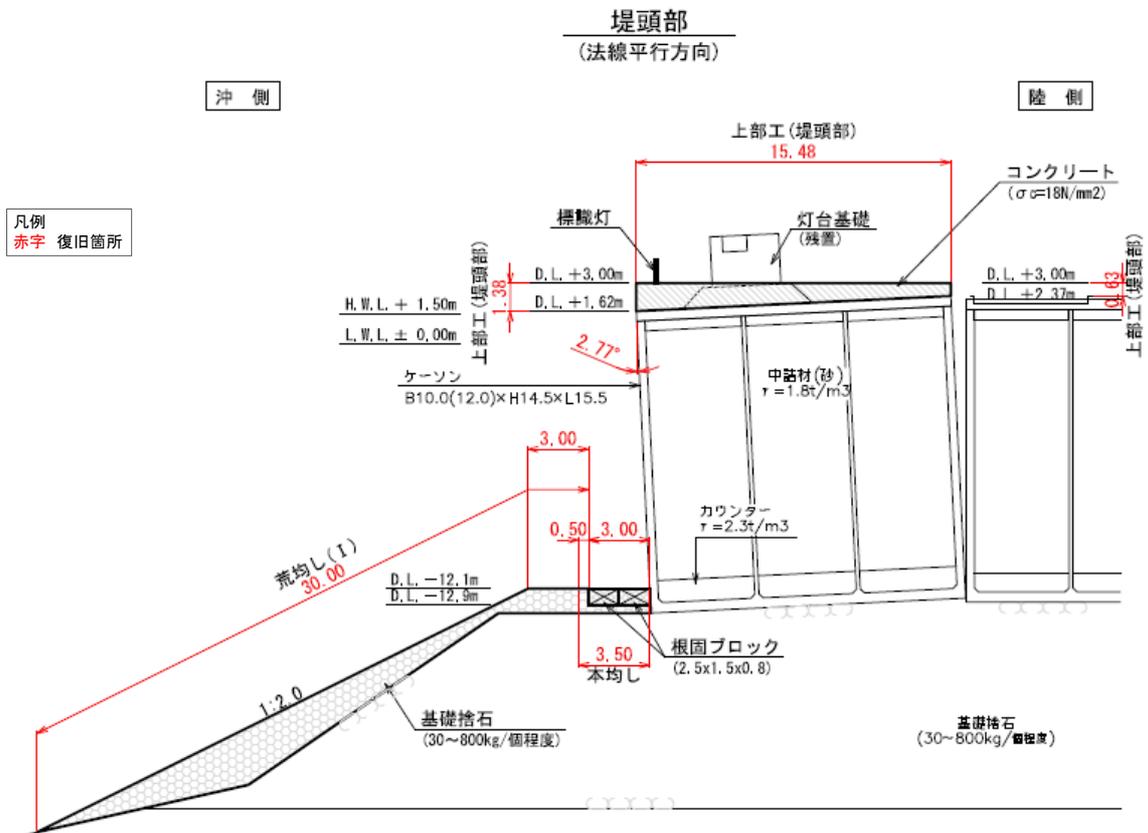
No.1 常陸那珂港区_北防波堤断面図(堤頭部②)(復旧後)
